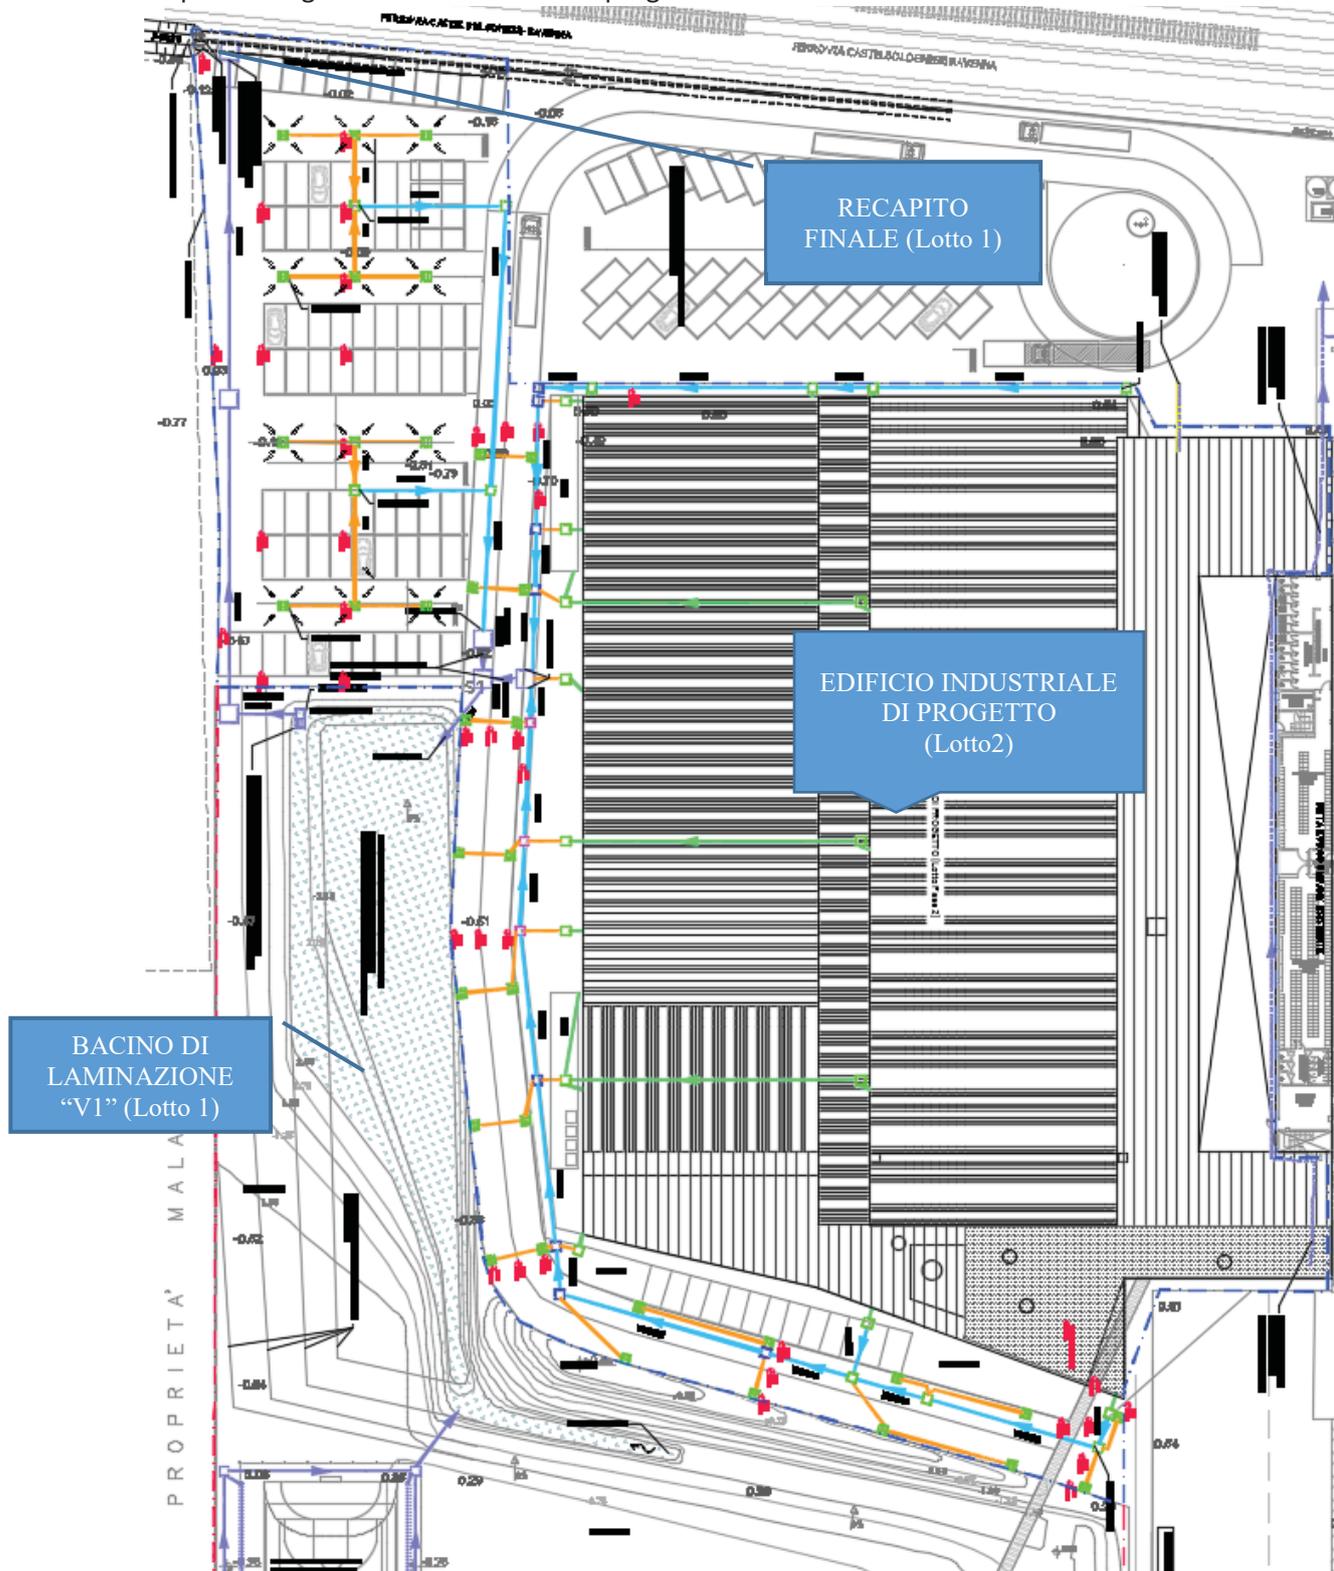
Rete acque meteoriche di progetto Lotto Fase 2 (collettori principali azzurri, gialli e verdi secondari), in viola le opere da realizzare preventivamente in Lotto Fase 1 (compreso il bacino "V1")
